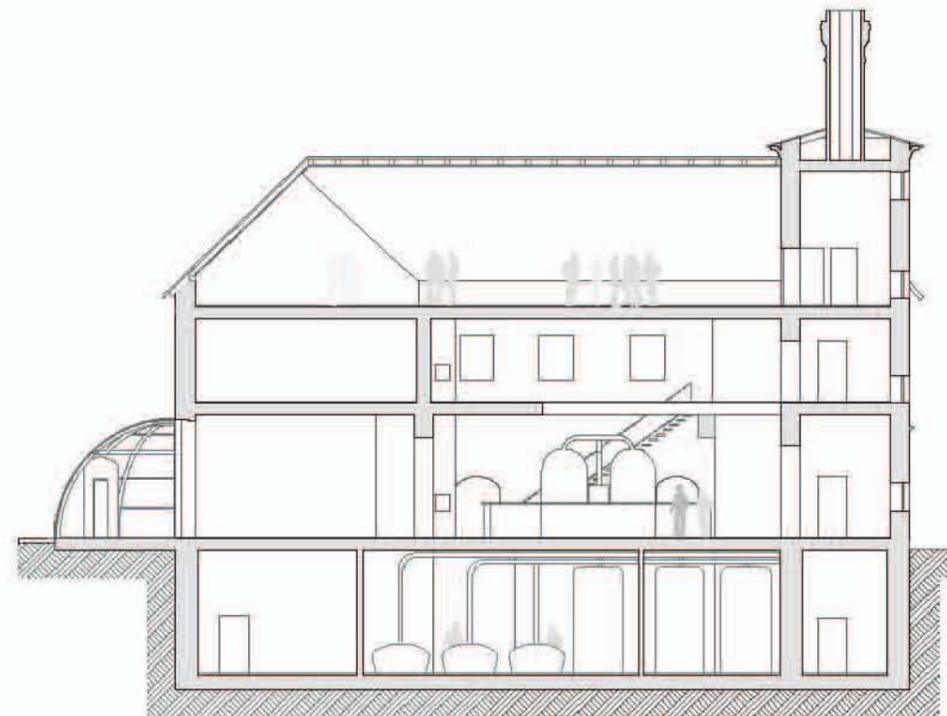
Schnitt D-D Restaurant (ehem. Sudhaus)
